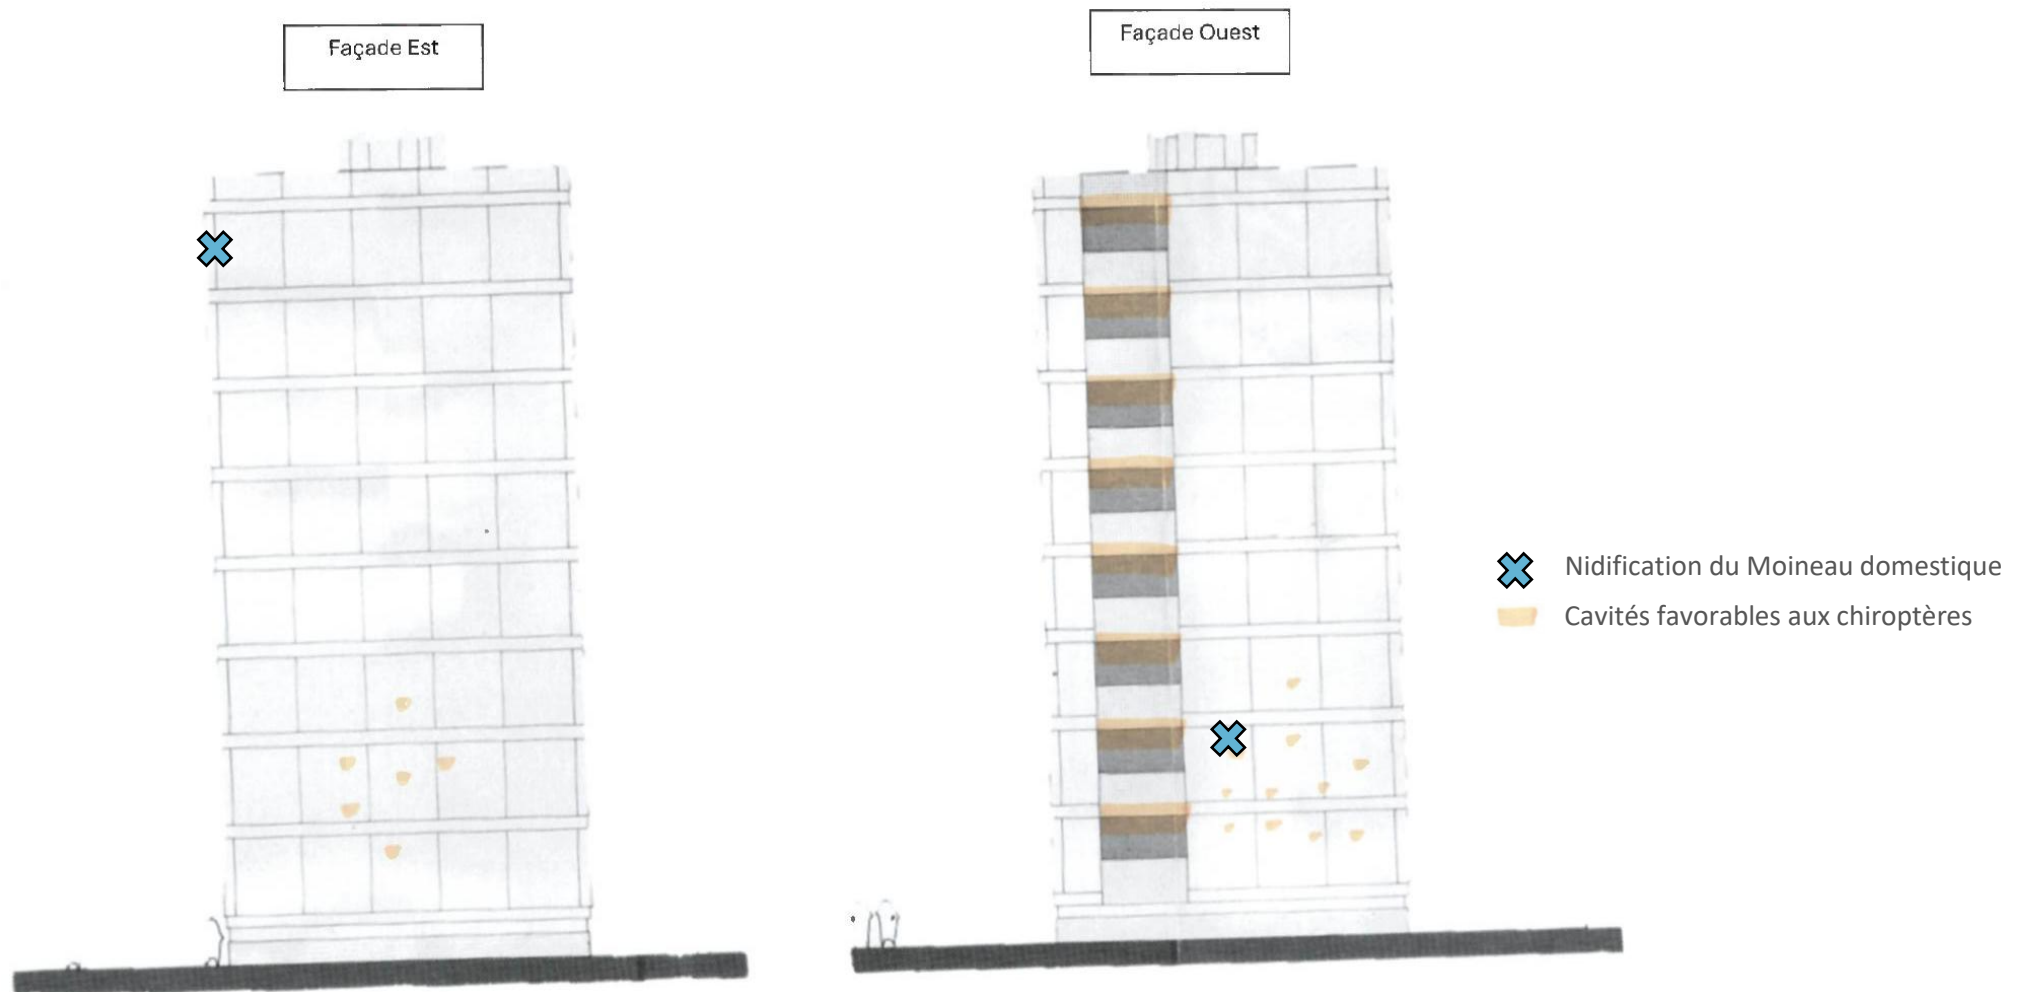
Plan du bâtiment 20 (façades est et ouest) des cavités favorables aux chiroptères et des Moineaux domestiques
